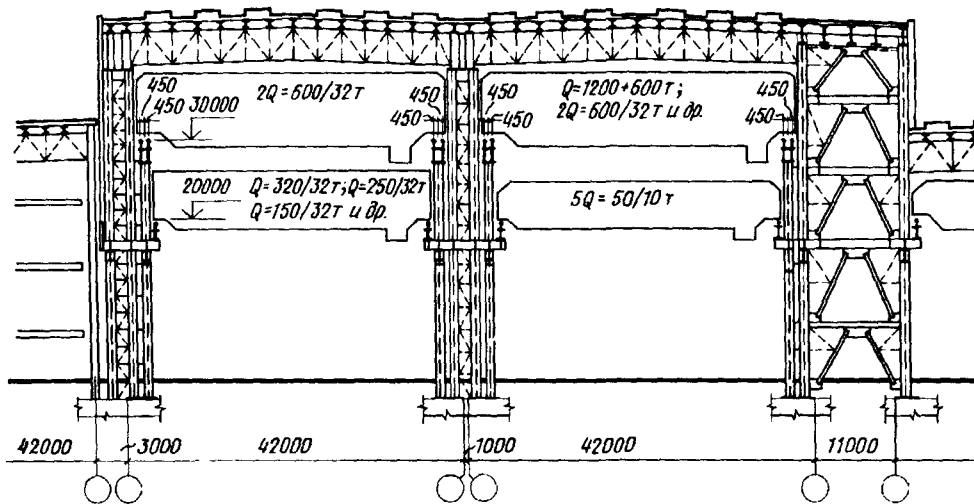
Разрез каркаса здания Атоммаша со сверхтяжелыми кранами
